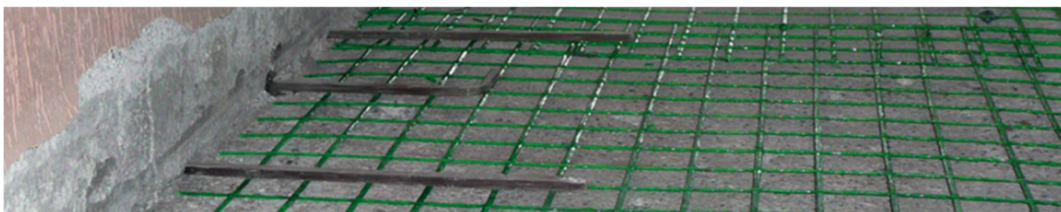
Reforzamiento y rigidización superior de placas con fibra de vidrio.
